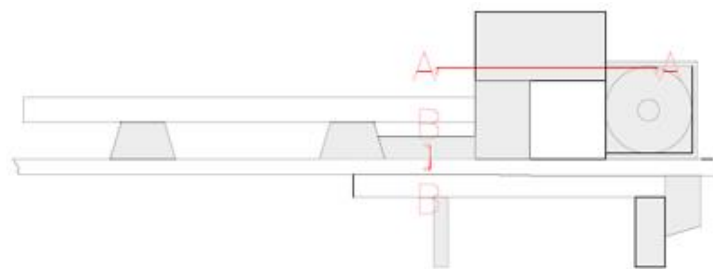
Planimetria piazzola (configurazione fornita dal montatore) in fase di cantiere
